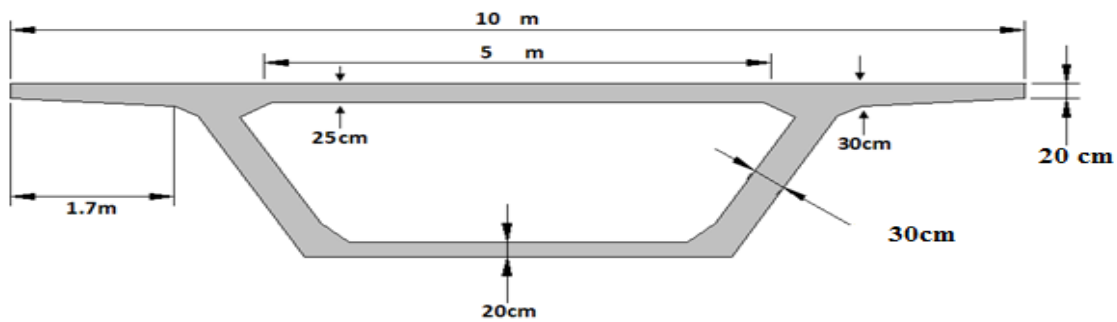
Description de la coupe transversale d'un voussoir en travée
